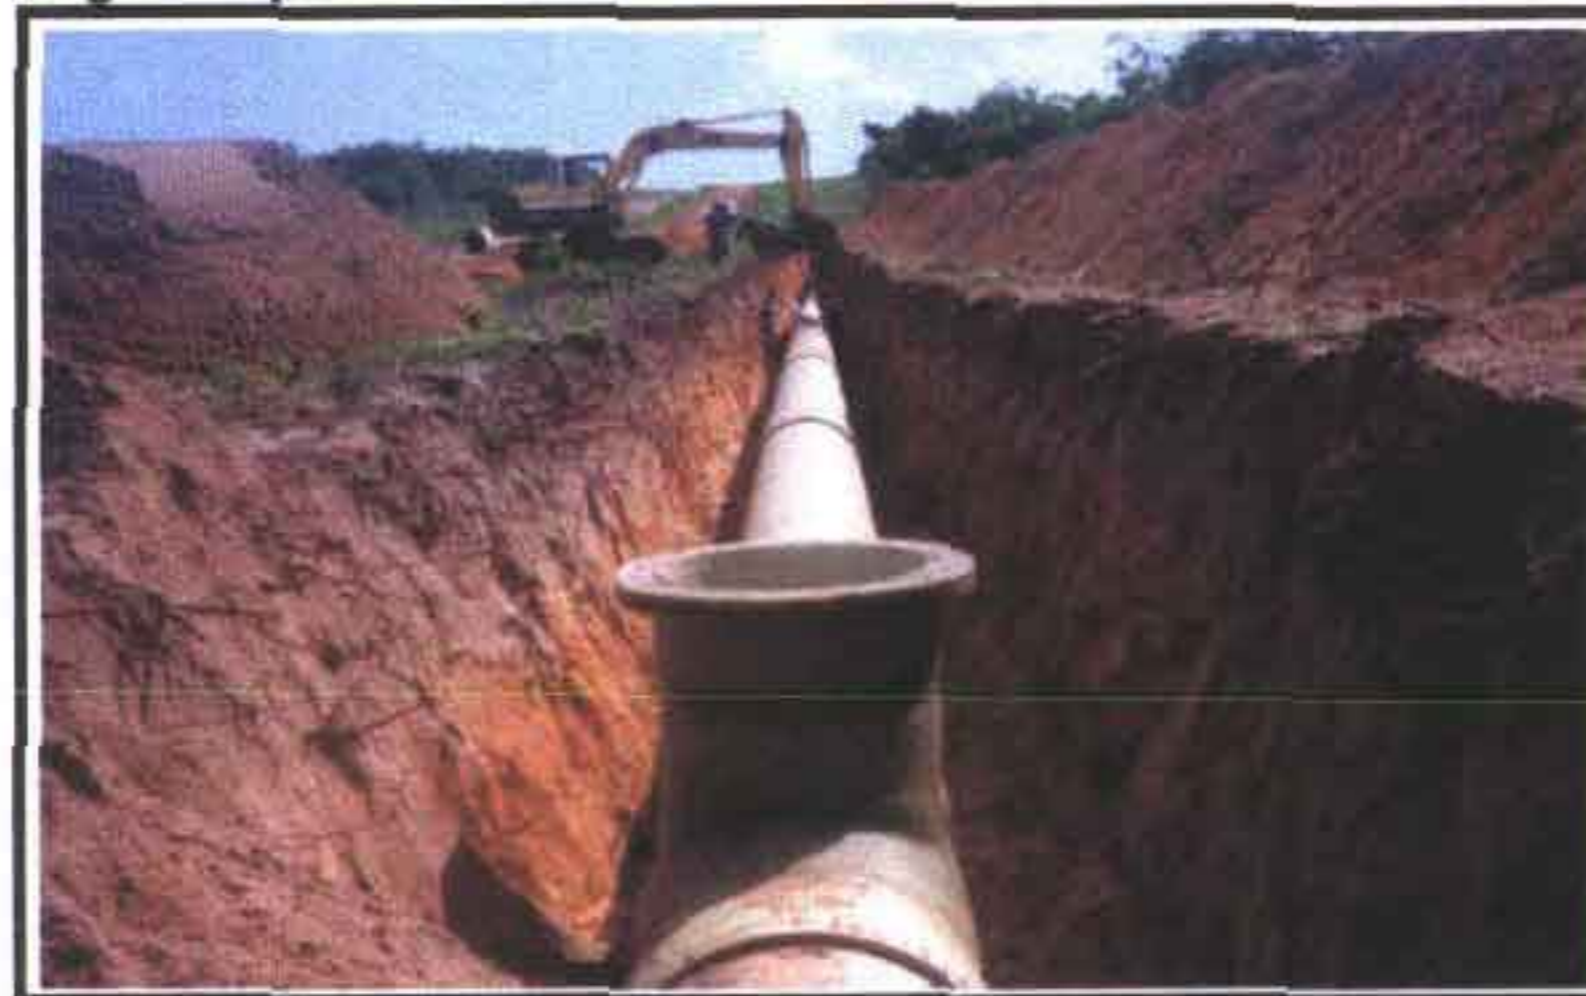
Assentamento de tubulação, executado com a utilização do equipamento de escavação de vala: retroescavadeira sobre esteira.
